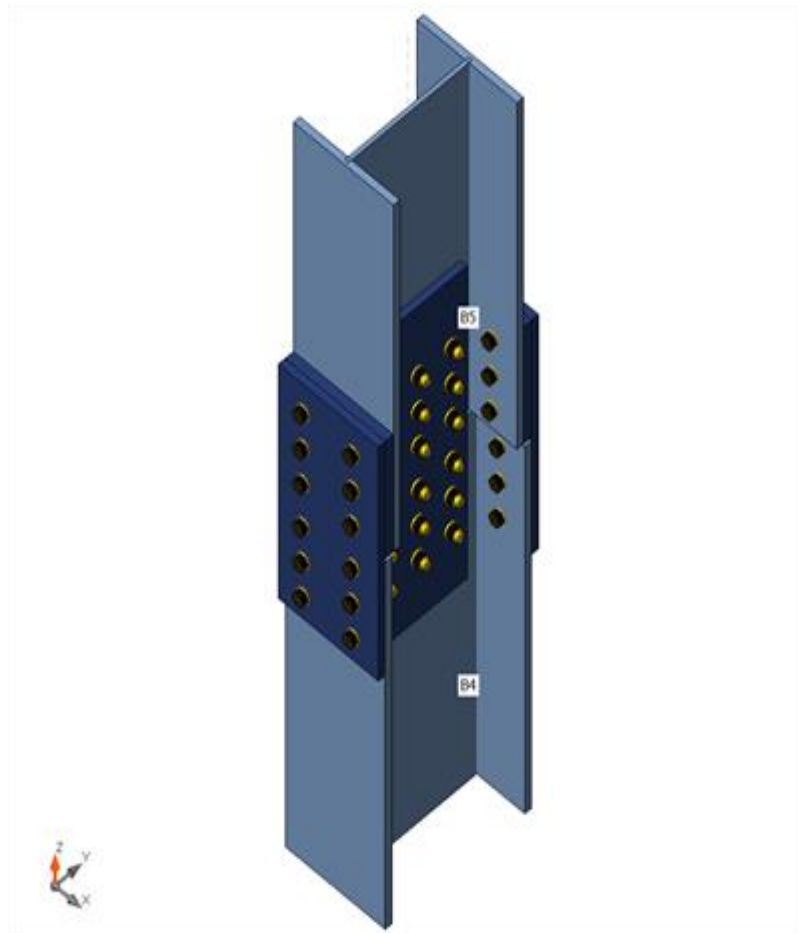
Vue d'assemblage Poteau HEA450 Poteau HEA400.
